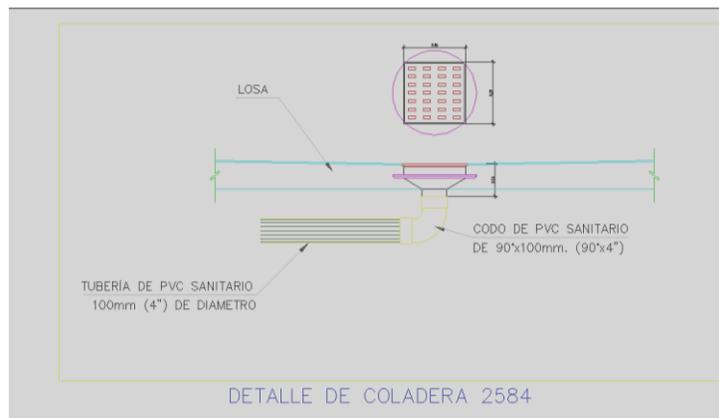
Detalle de colocación de coladeras comunes en el área del proyecto.
